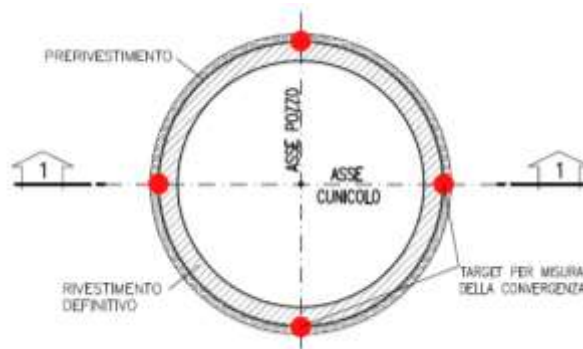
Ambito 08 – NV95 – Sezione muro di rivestimento e tratto terminale del pozzo
